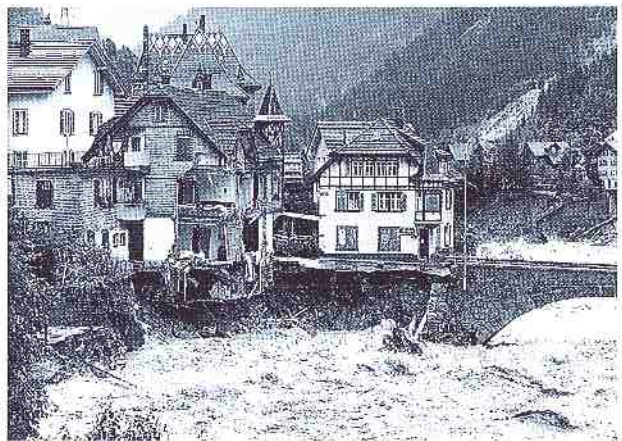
Zerstörte Kantonsstrasse südlich der Wilerbrücke (Comet Photo AG, Zürich).
